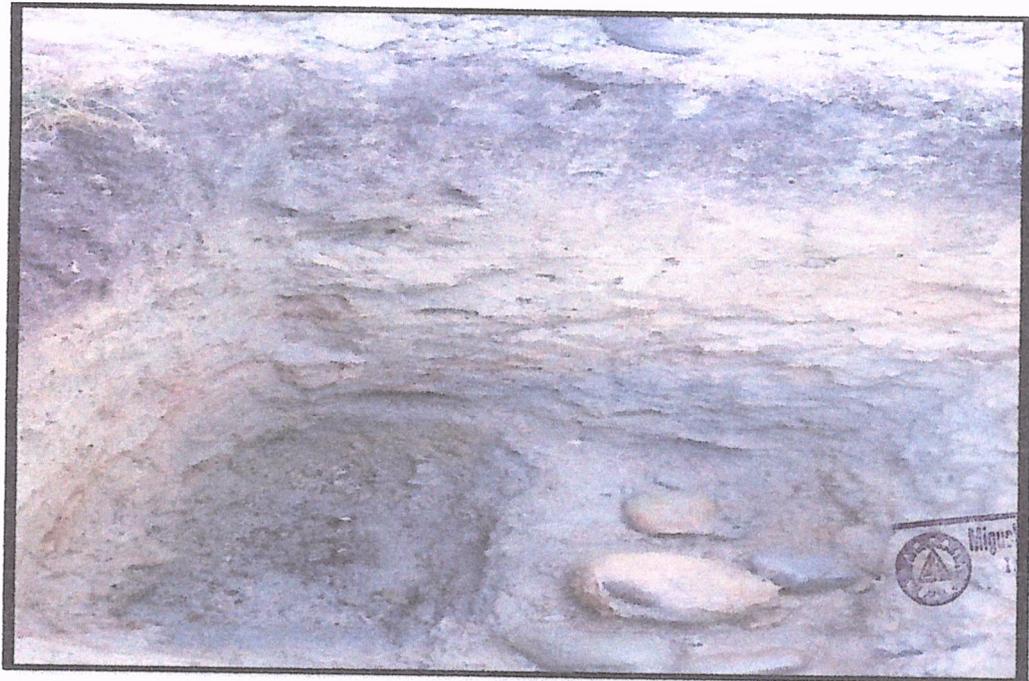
Excavación la zona donde se proyecta la Captación N°02 C-2.
